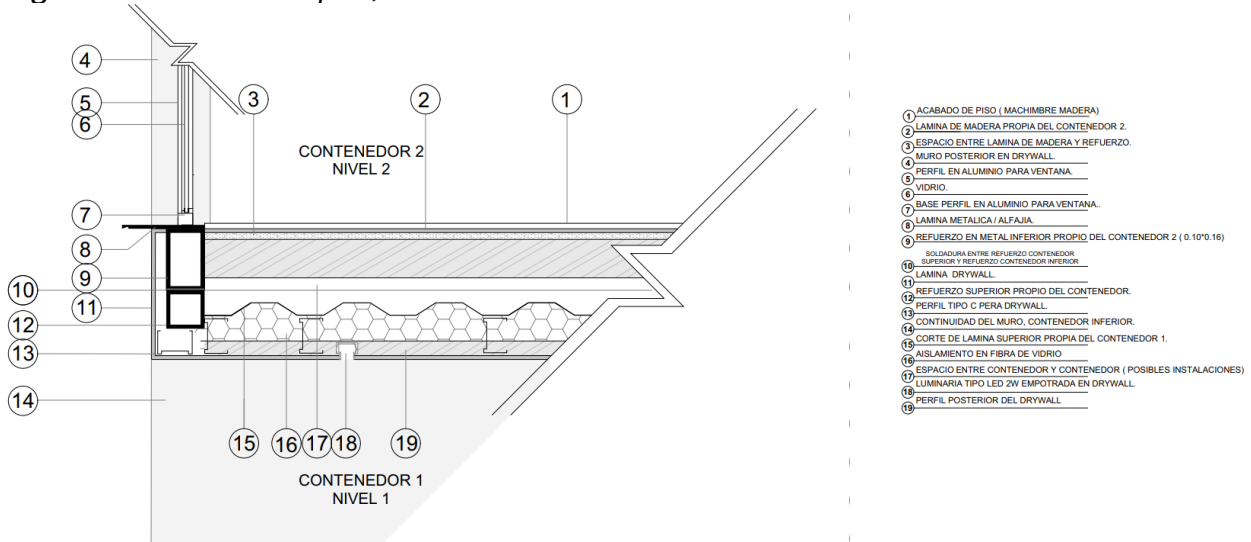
Detalle canal aguas lluvias- drywallFigura 62. Detalle de cimentaciónFigura 63. Detalle entrepiso, contenedor sobre contenedor
